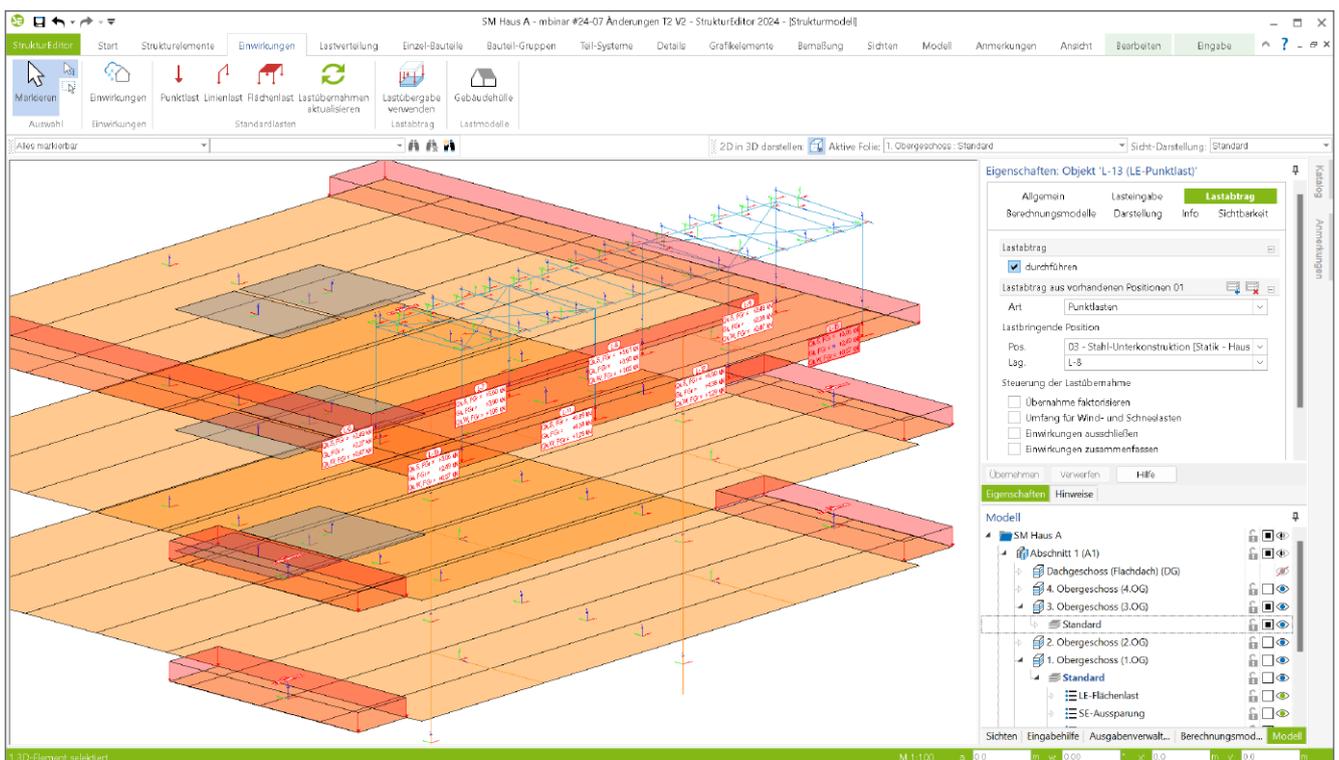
Bauteilbezogene Lasten und Last-Elemente für die Geschossdecken
